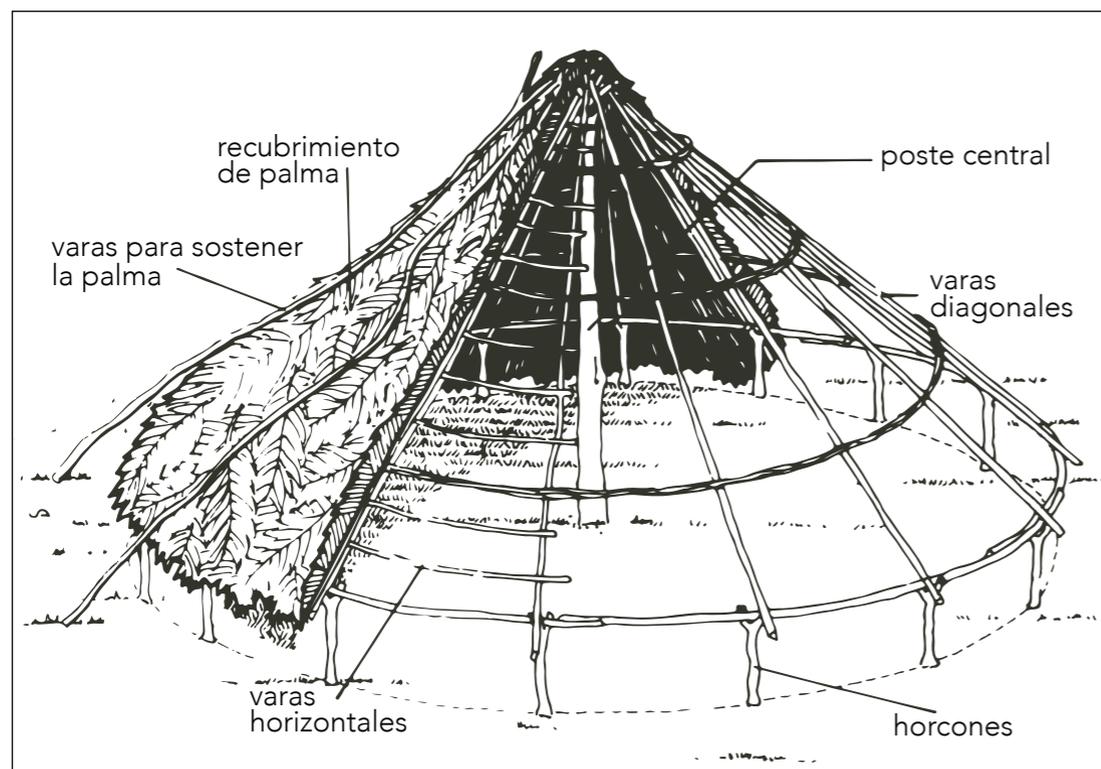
Croquis de estructura de la casa lacandona de planta redonda.
